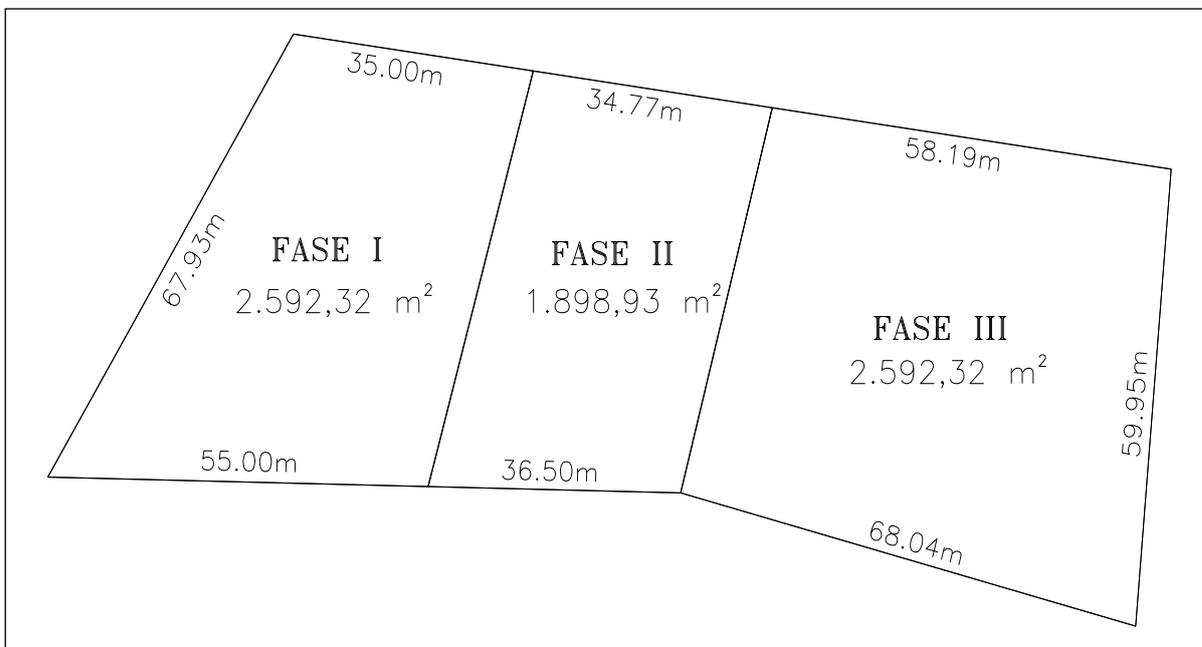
Planta baixa da Área de Implantação da Célula de Disposição de Resíduos Sólidos.
